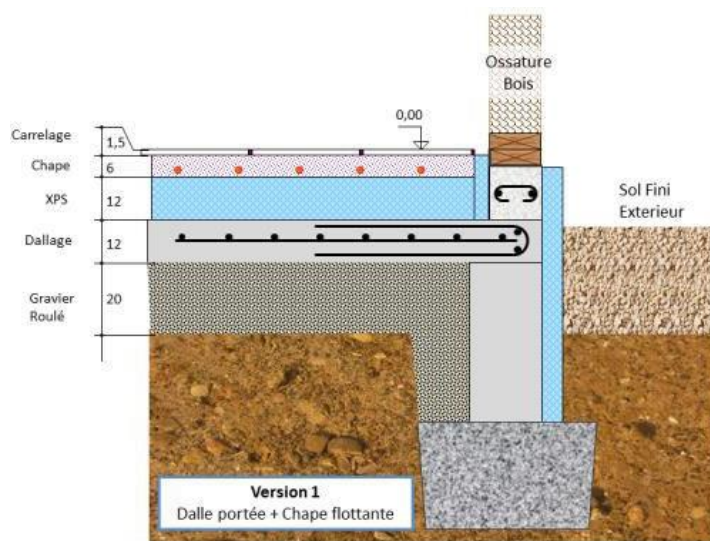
Schéma de dalle flottante sur terre-plein.
